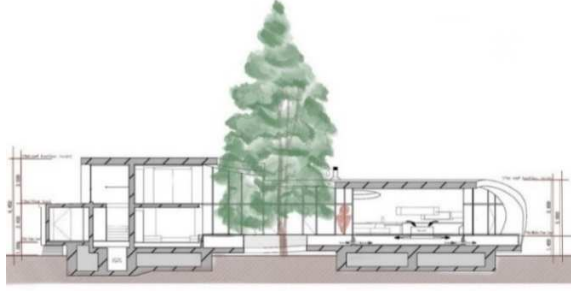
Shell House'un genel görünümü (Ohara 2008)
